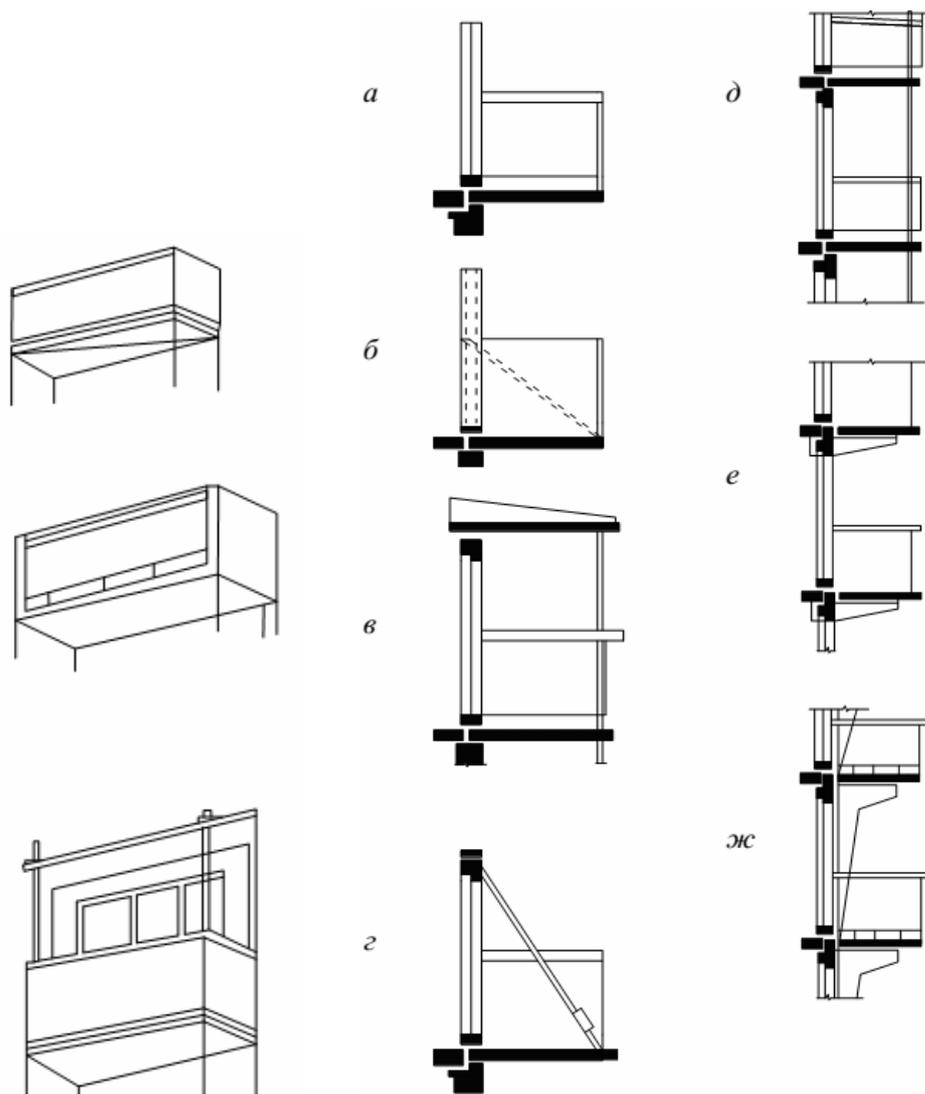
Примеры опирания балконных плит: *а* — с защемлением в наружной стене; *б* — на наружные стены и подвеску к поперечным внутренним стенам; *в* — то же, к карнизной плите; *г* — на перекрытия; *д* — на наружные стены и стойки; *е* — на консоли; *ж* — на приставные опоры
